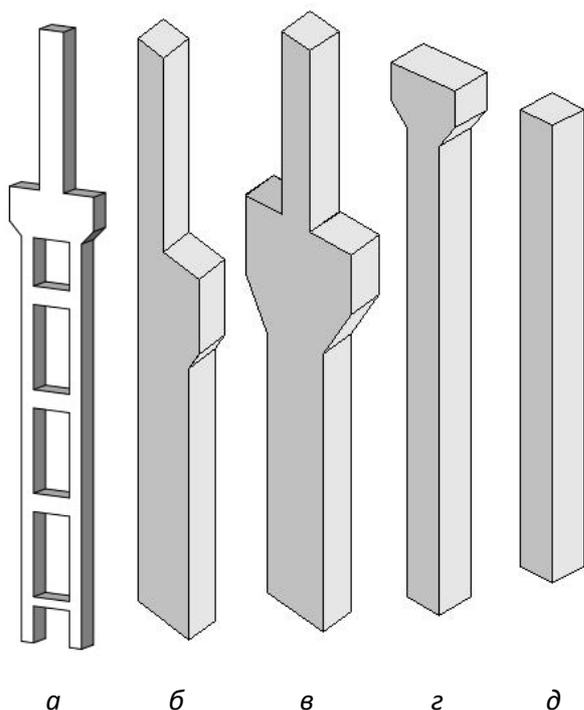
Колонны железобетонные для промышленных зданий:
